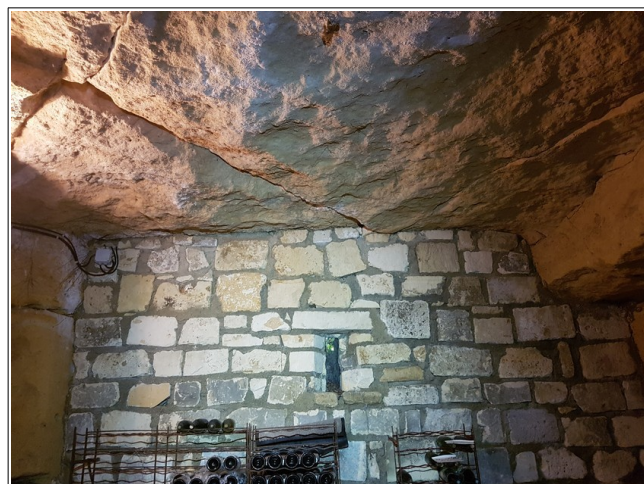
int rieur de la salle 2. On notera la fissuration du ciel. Le mur en pierres ma onn es isole la salle de l'ext rieur.
